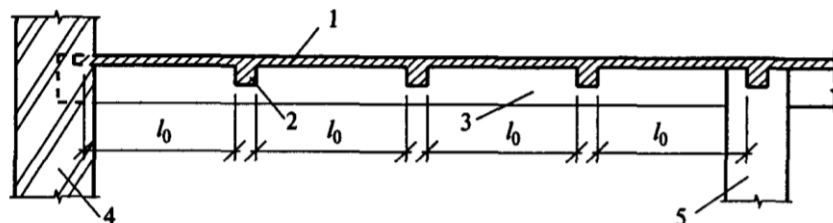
Конструктивная схема монолитного перекрытия:
